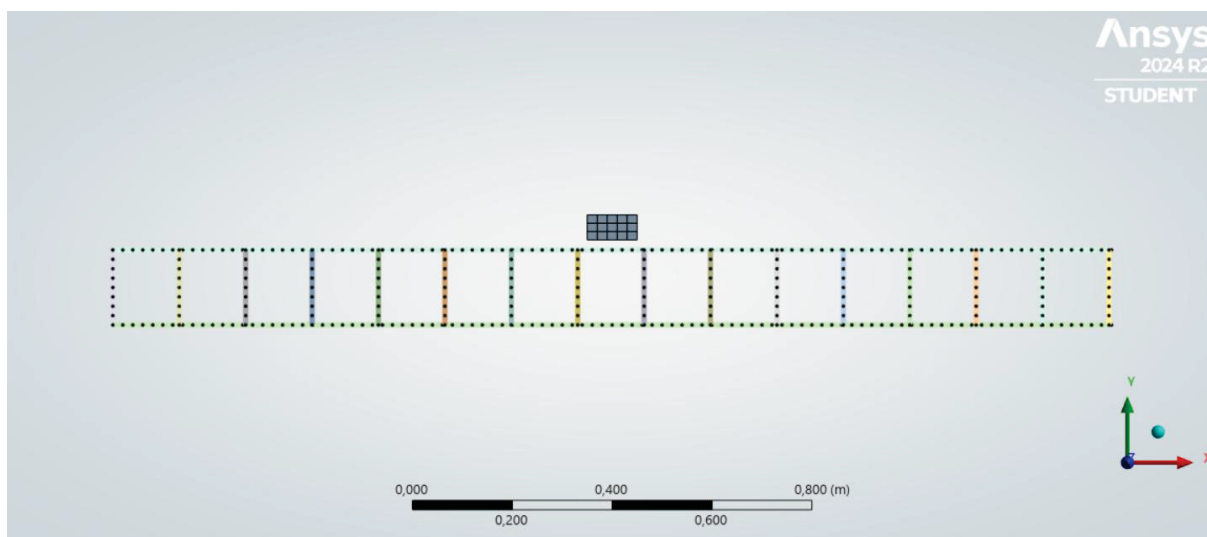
Modelagem da armadura de aço CA50.
